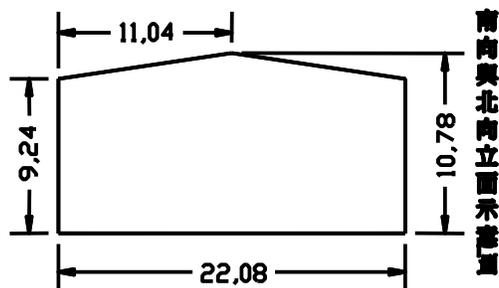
低層廠房南向與北向立面示意圖 單位 (m)
